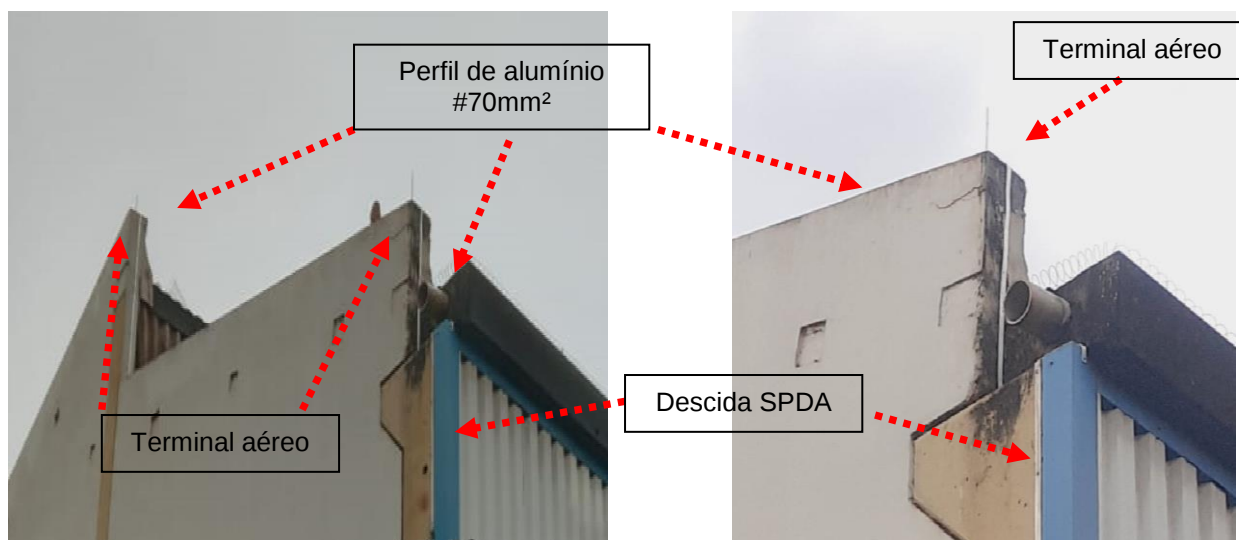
e 116: Implantação de malha captora e terminais sobre a platibanda em alvenaria.
